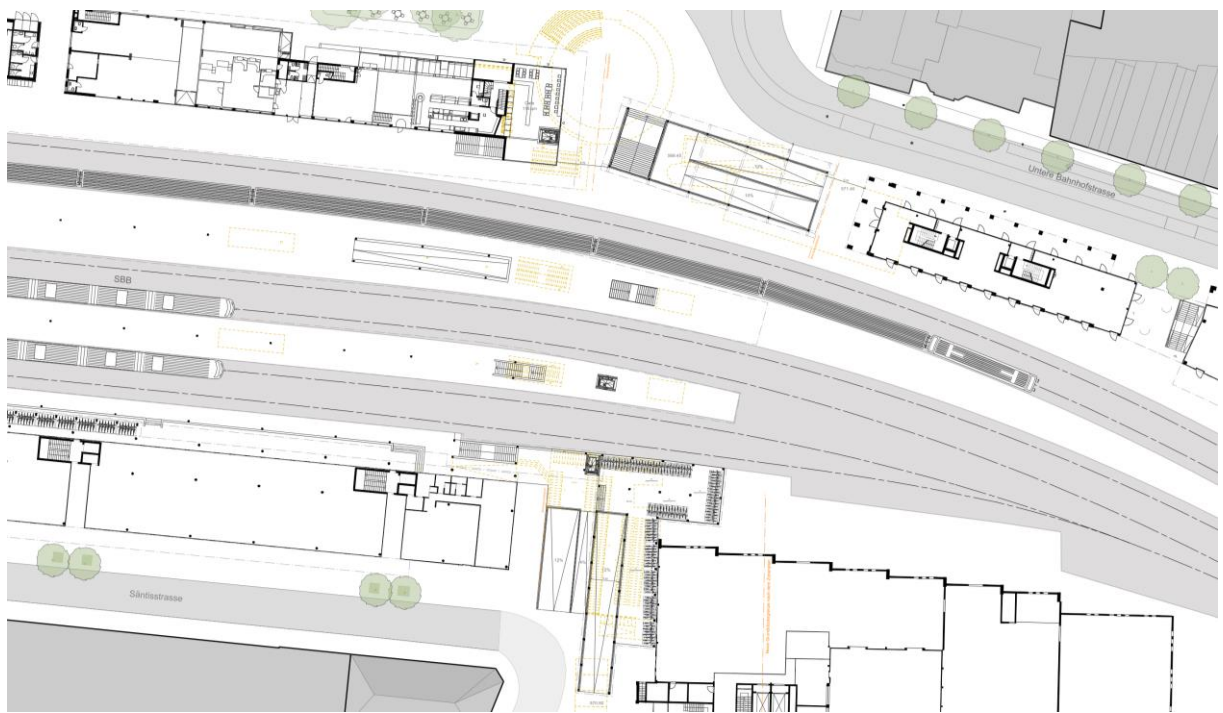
Grundriss EG, Provisorischer Zustand Südseite
